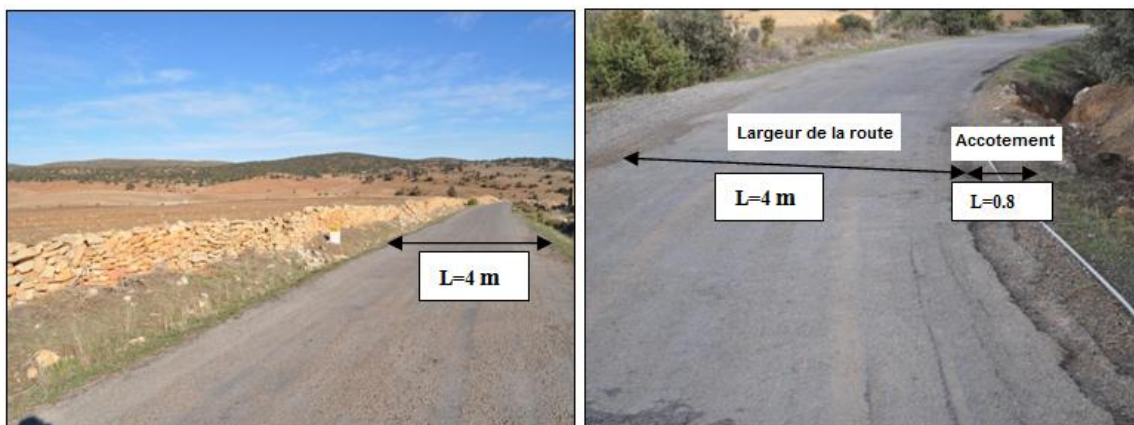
Aperçu sur le profil en travers de la route existante
